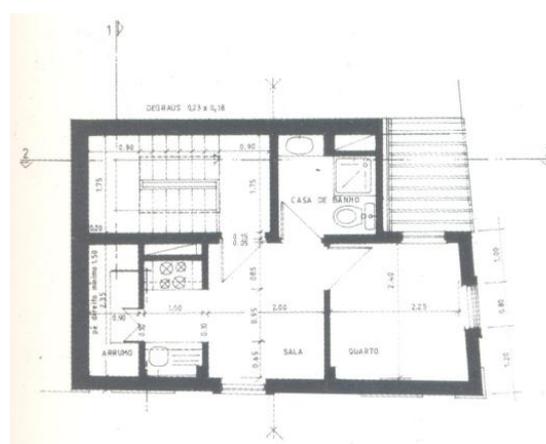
Planta do 5º pavimento na travessa do Poço da Cidade nº 52-54. LISBOA, 1993, p.103.
